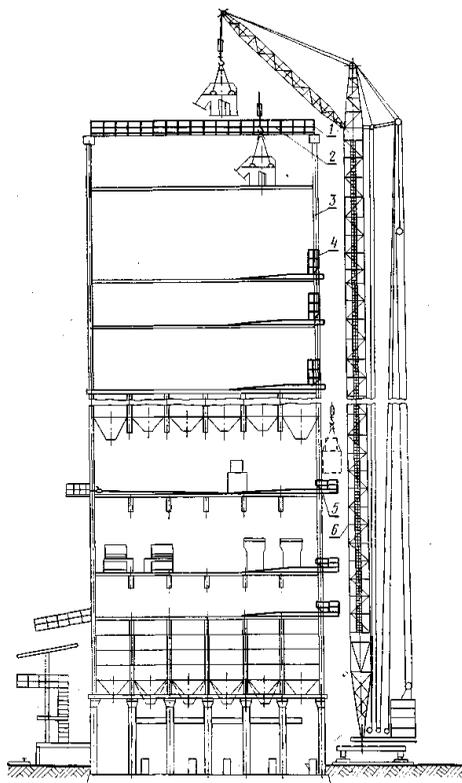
Схема подъема оборудования башенным краном на этажи здания элеватора: 1 – ограждение; 2 – монтажный проем в крыше; 3 – монтажный проем в стене; 4 – площадка для приема оборудования в нерабочем положении; 5 – площадка для приема оборудования в рабочем положении; 6 – башенный кран
